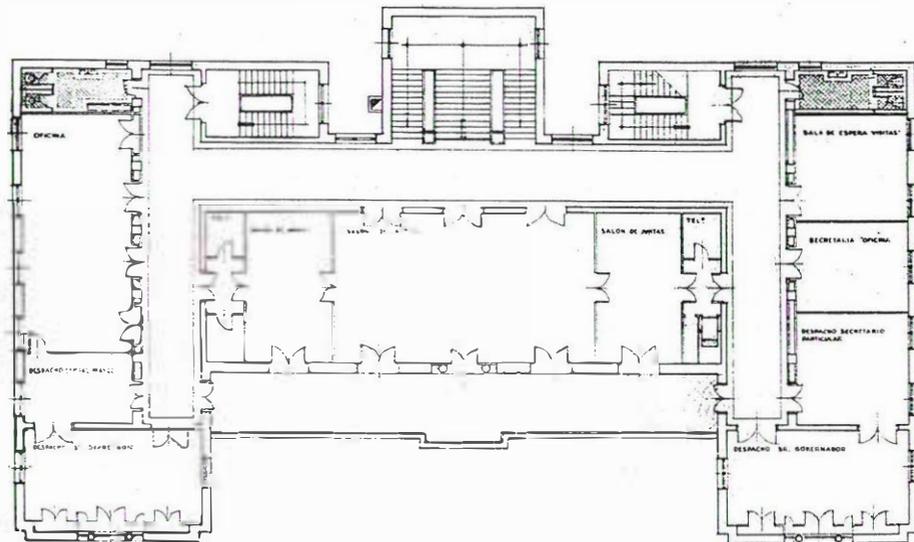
Planta principal del Gobierno Civil (1.940)
